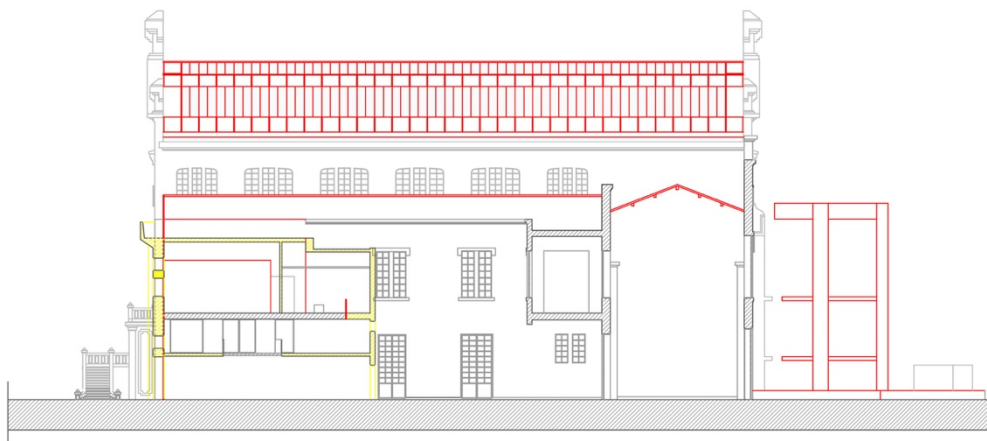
Sobreposição dos elementos a construir e a demolir, corte c;
